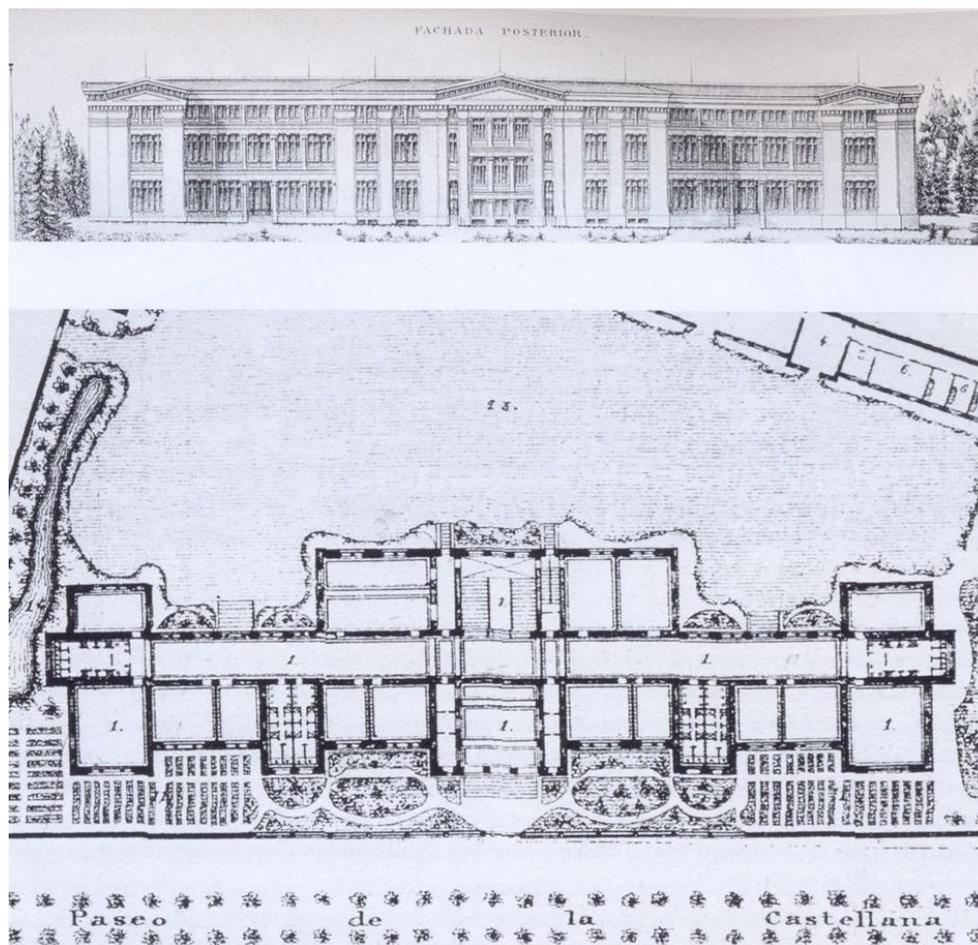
Fachada e planta de uma escola pavilhonar, do fim do século XIX, na Espanha.
